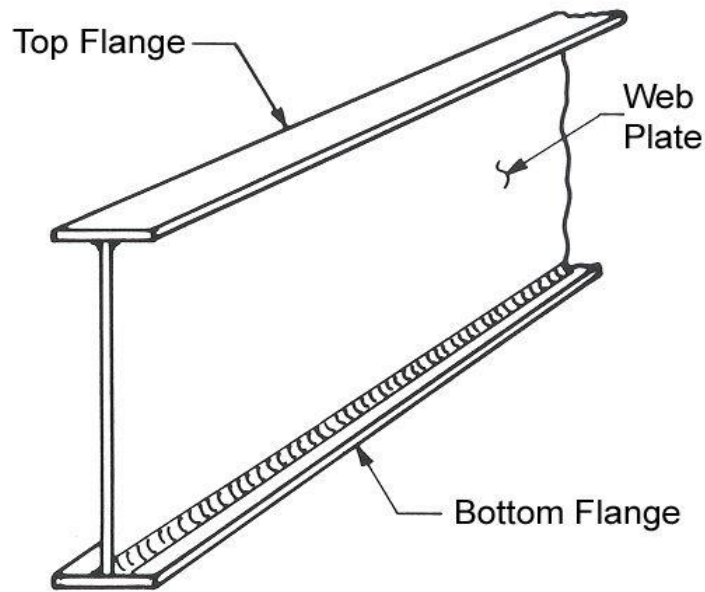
Esquema de una viga armada (con su cordón de soldadura)
